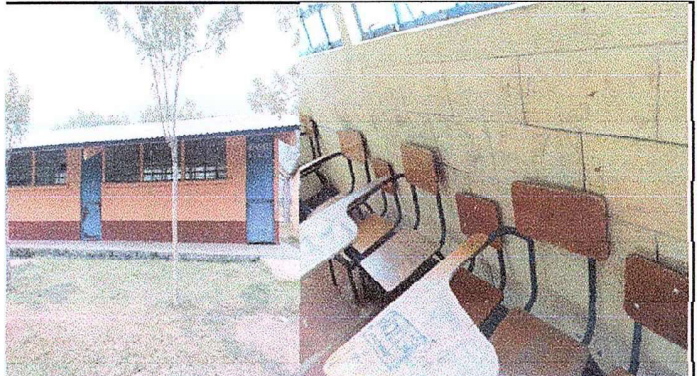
Modulo 2. Pintura en muros interiores y exteriores
